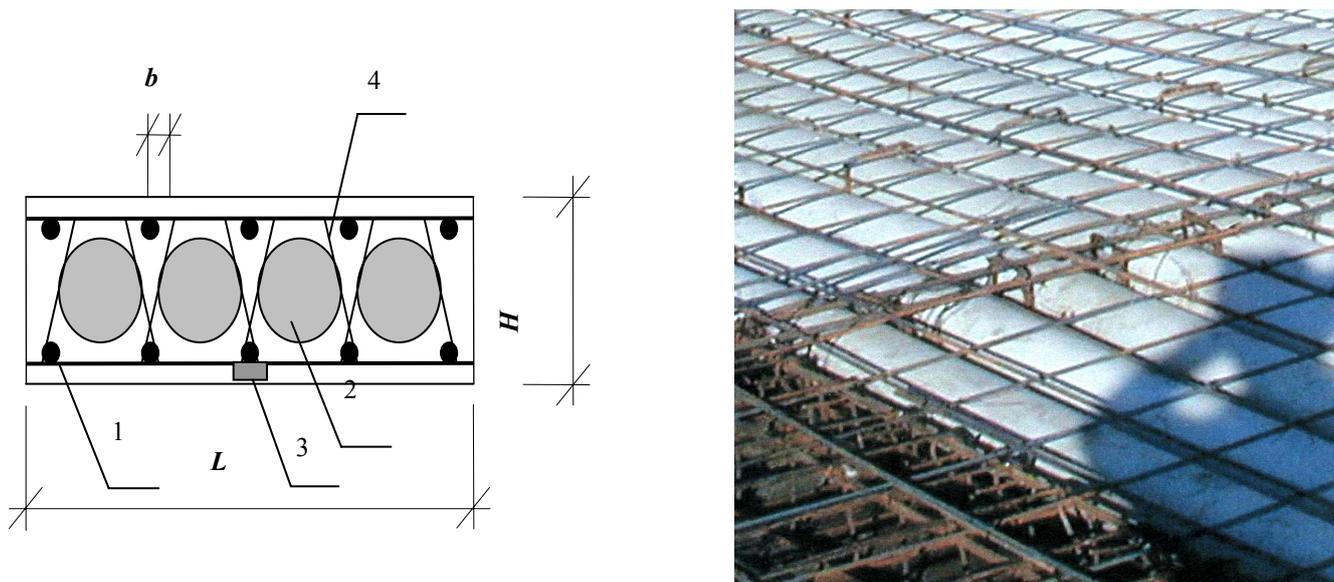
Плоские плиты с пустотами в виде труб (КР2-1).
